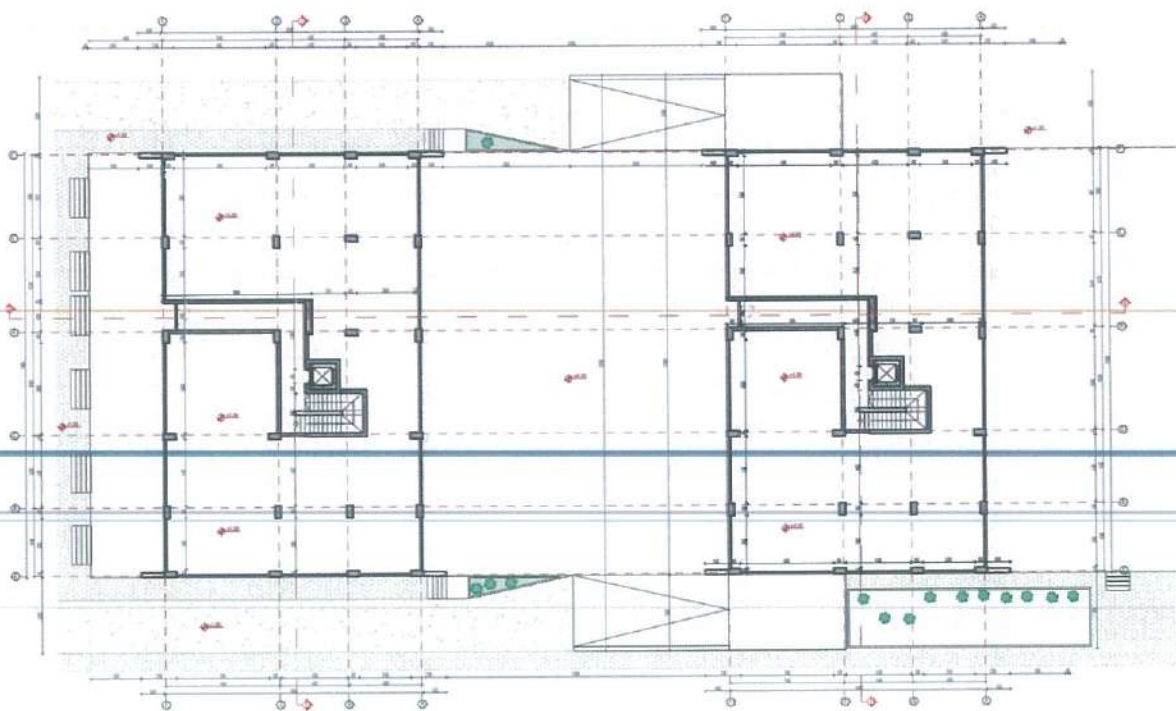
Planimetria e katit përdhe objekti 1 & 2
